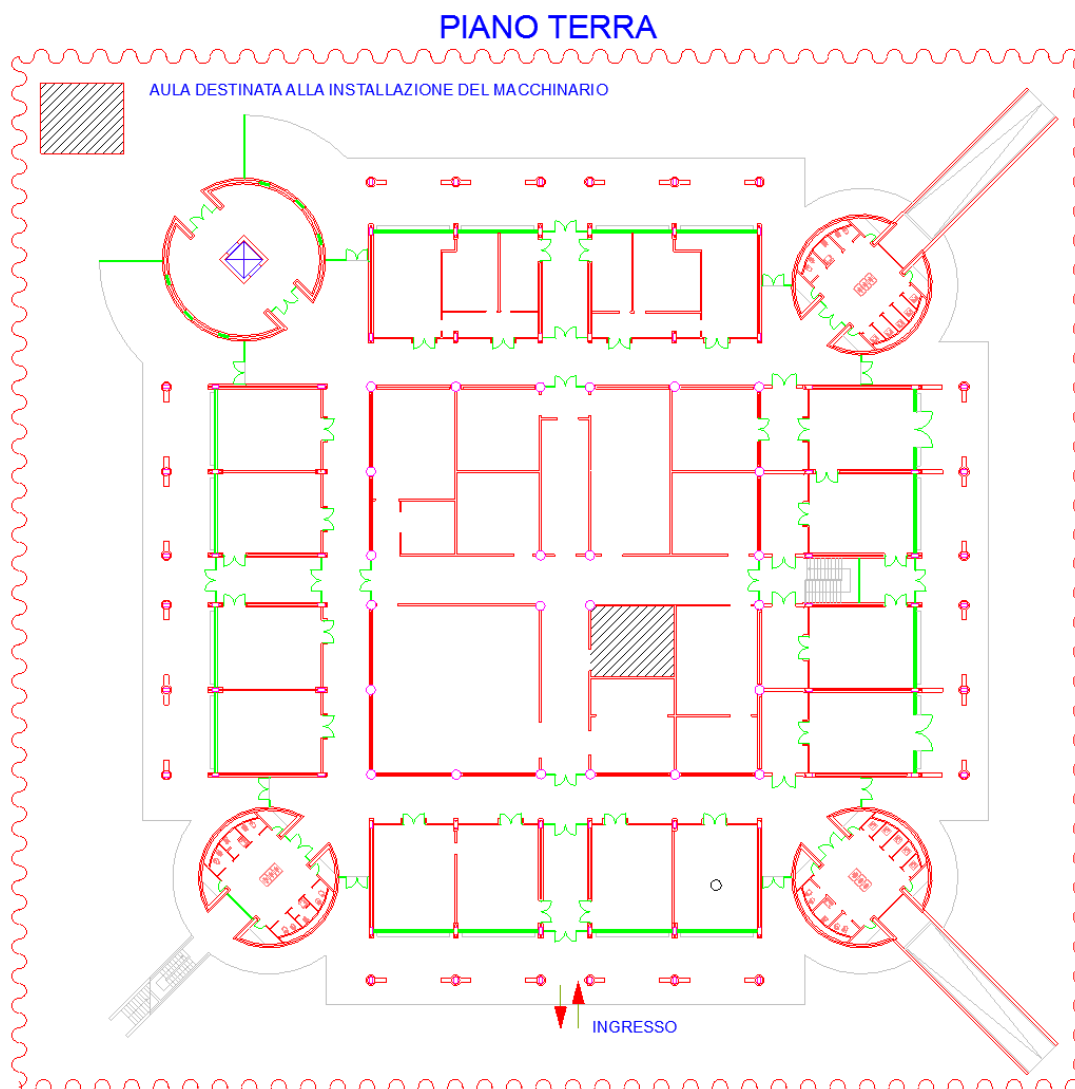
Pianta Piano terra ed aula oggetto dell'installazione
